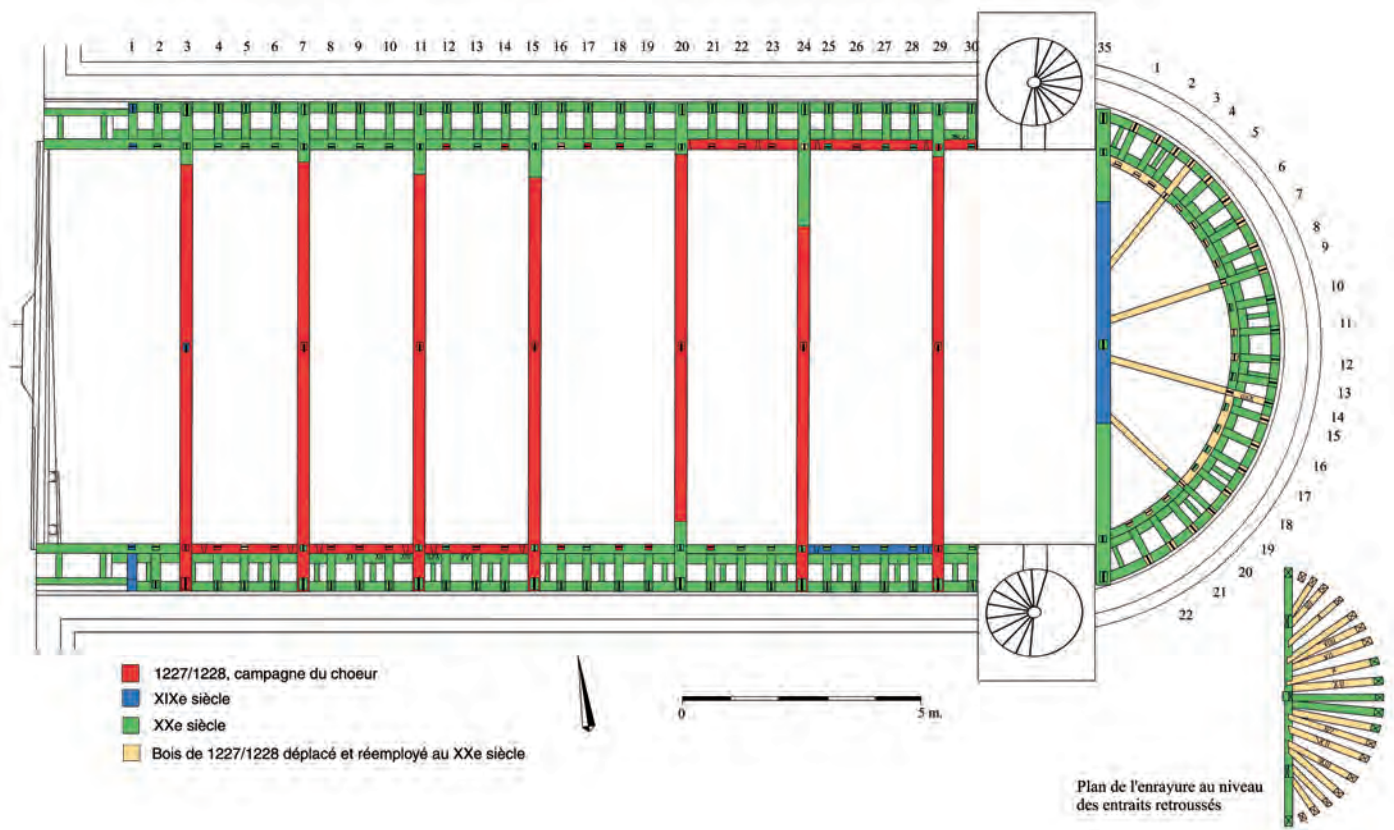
Charpente du chœur, plan au niveau des entrails.
